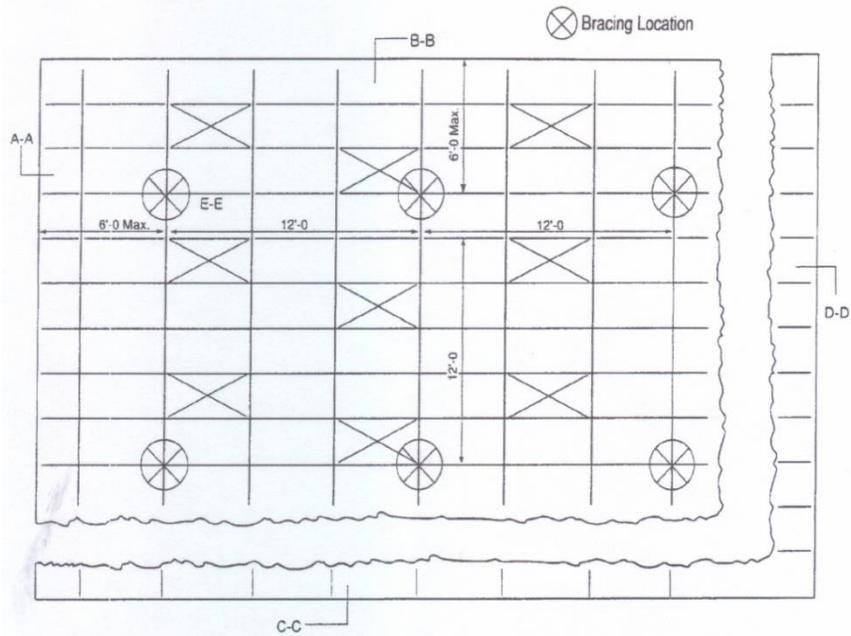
“Bracing Location” (alambres para fuerzas laterales, ubicación):
